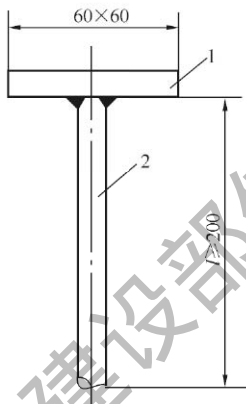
预埋件钢筋 T 形接头拉伸试件
